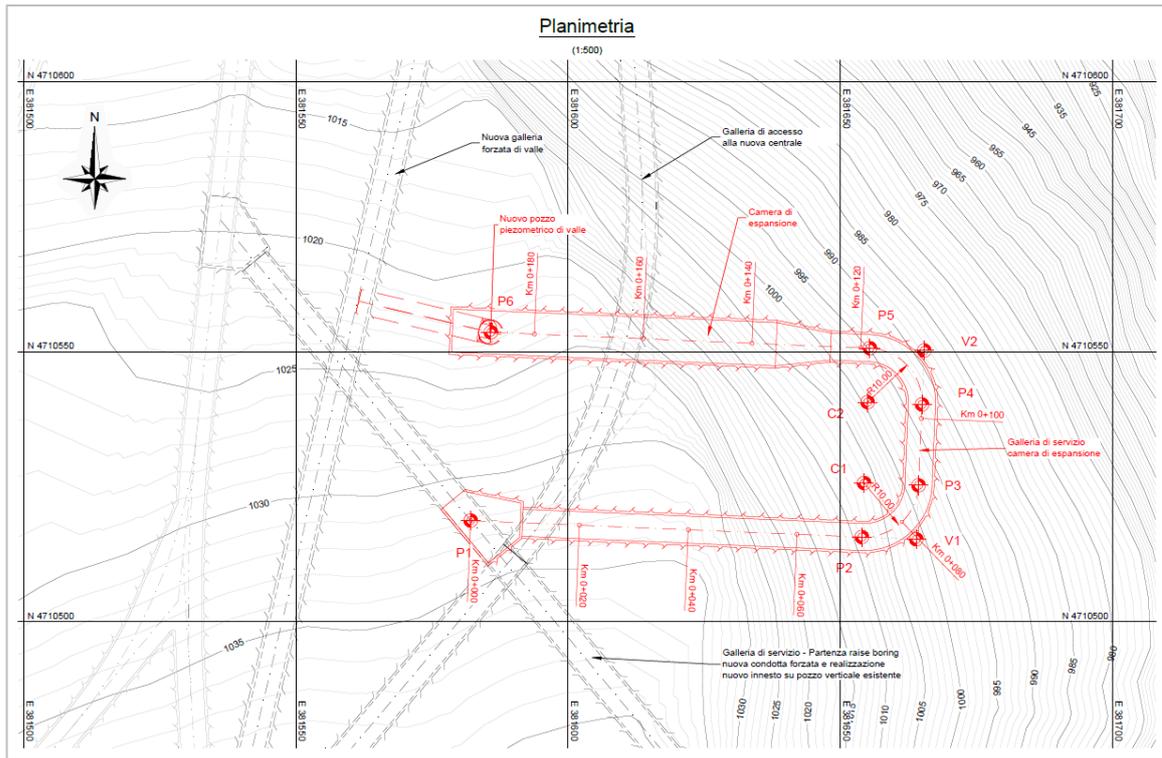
Nuovo pozzo piezometrico sulla derivazione Piaganini – pianta
